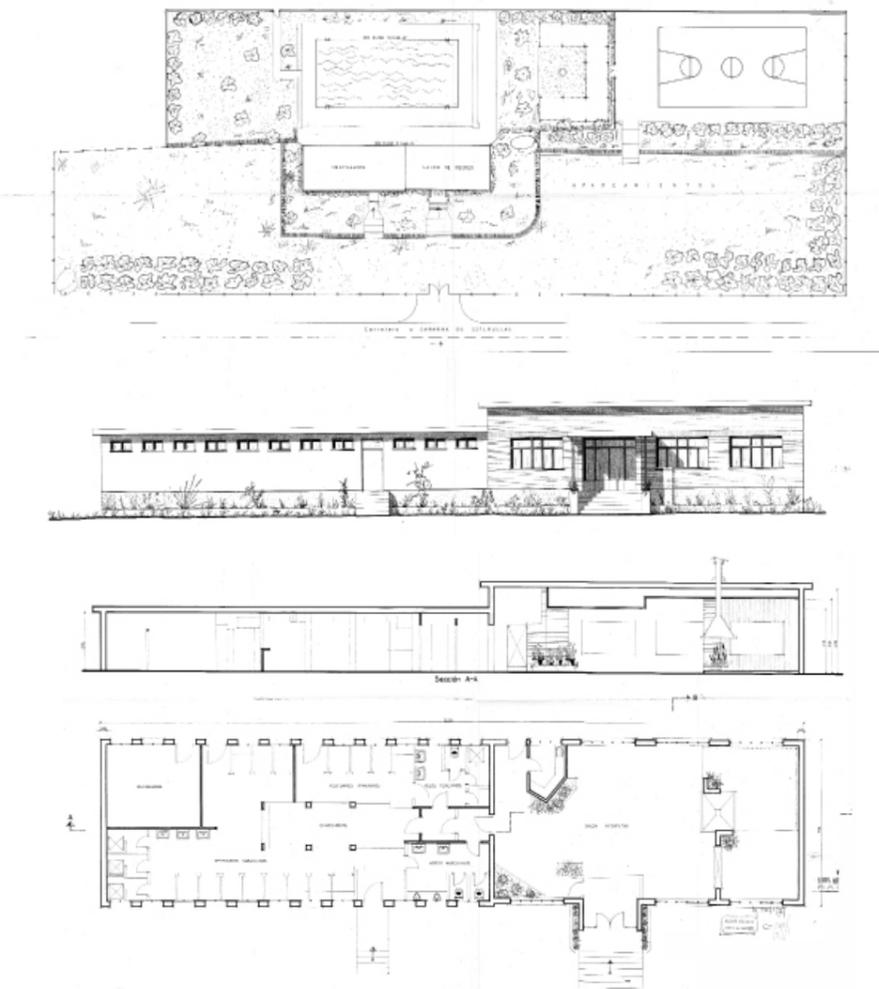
Zonas deportivas de Poliseda, de arriba a abajo: planta general (escala 1:200), alzado este, sección longitudinal y planta baja (escala 1:50)
